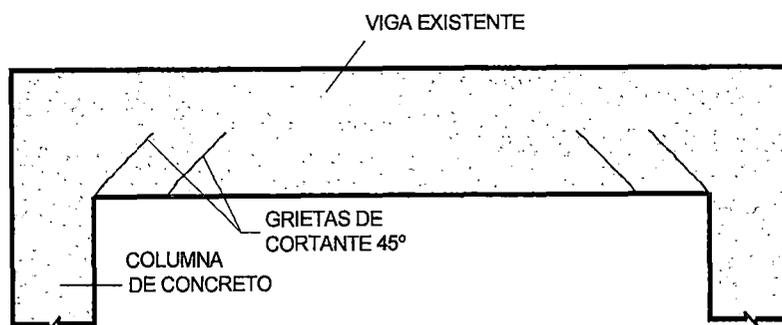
Grietas inclinadas en viga existente.
